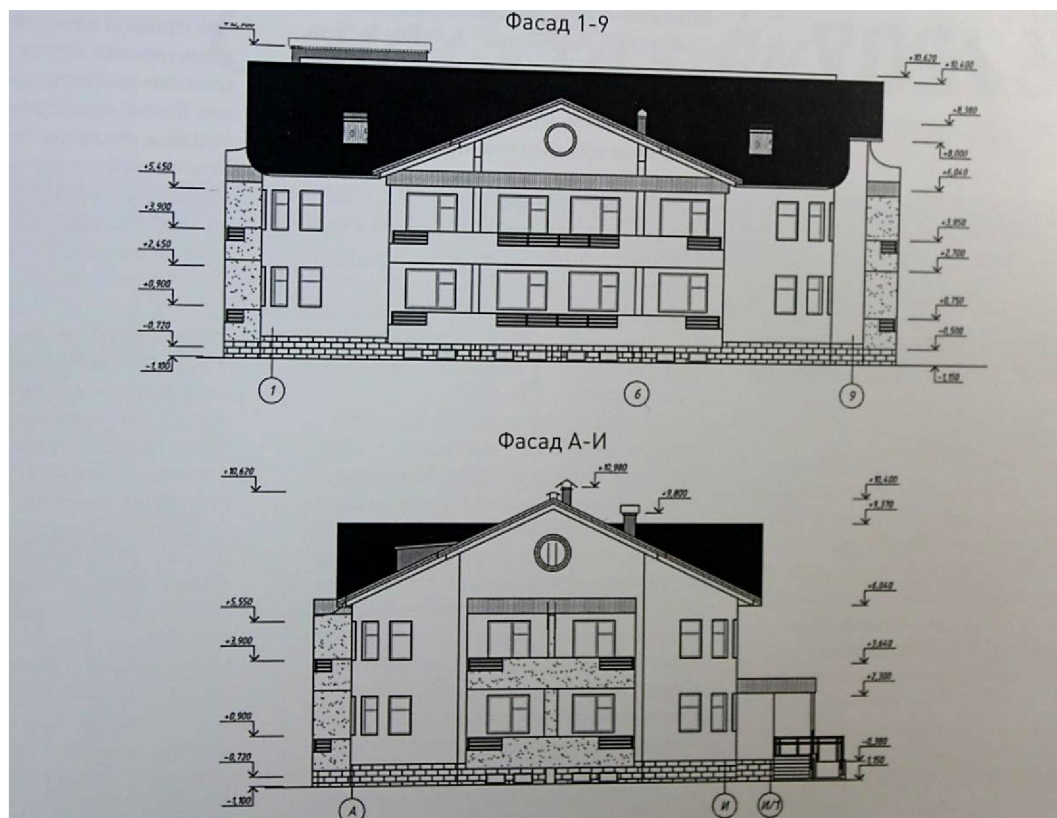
Фасад 1-9 и А-И 12-квартирного двухэтажного дома
